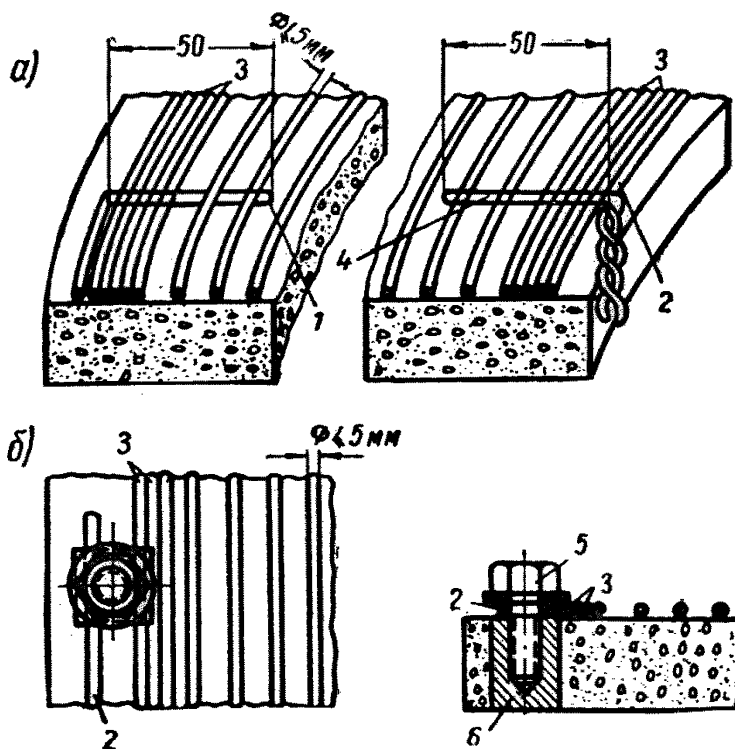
Анкерование арматуры в предварительно напряженных железобетонных конструкциях круглого сечения
